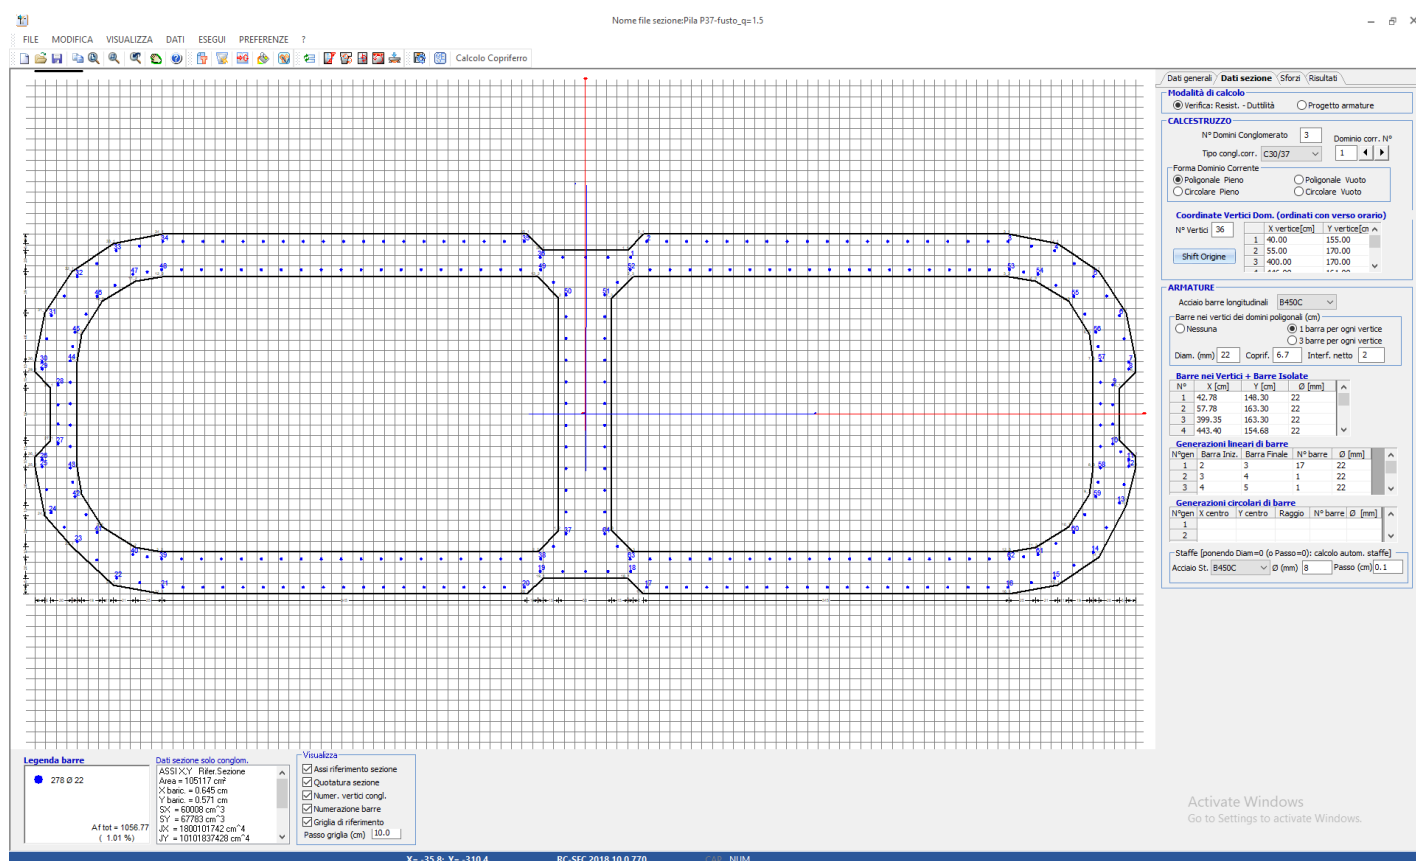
Fusto – Geometria sezione allo spiccato
